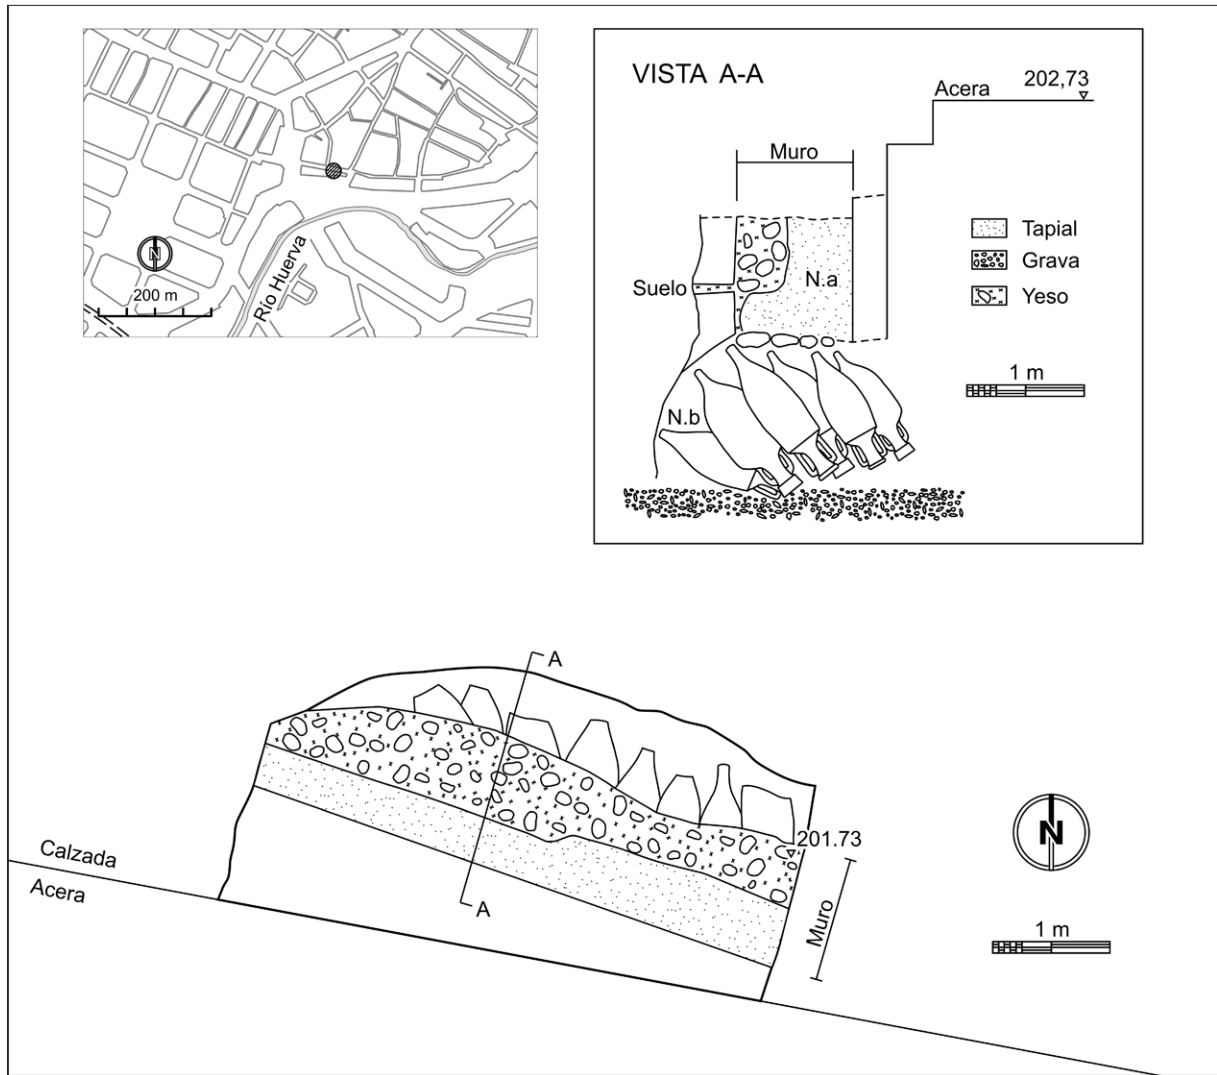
(plano 1). Planimetría, sección y ubicación de la excavación de la c. Reconquista.
